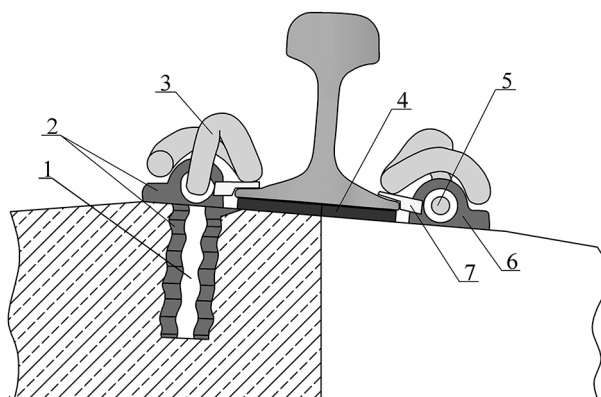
Рельсовое промежуточное скрепление системы Pandrol E-Clip: 1 — хвостовик анкера; 2 — анкер; 3 — упругая клемма; 4 — изолирующая прокладка; 5 — проушина реборды; 6 — часть анкера, лежащая на верхней постели шпалы и образующая реборду; 7 — нейлоновая прокладка-изолятор
